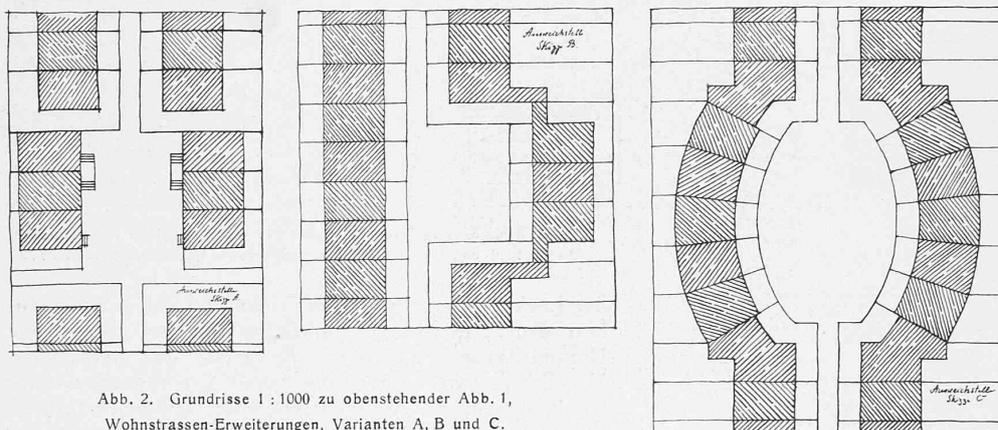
Grundrisse 1:1000 zu obenstehender Abb. 1, Wohnstrassen-Erweiterungen, Varianten A, B und C.
